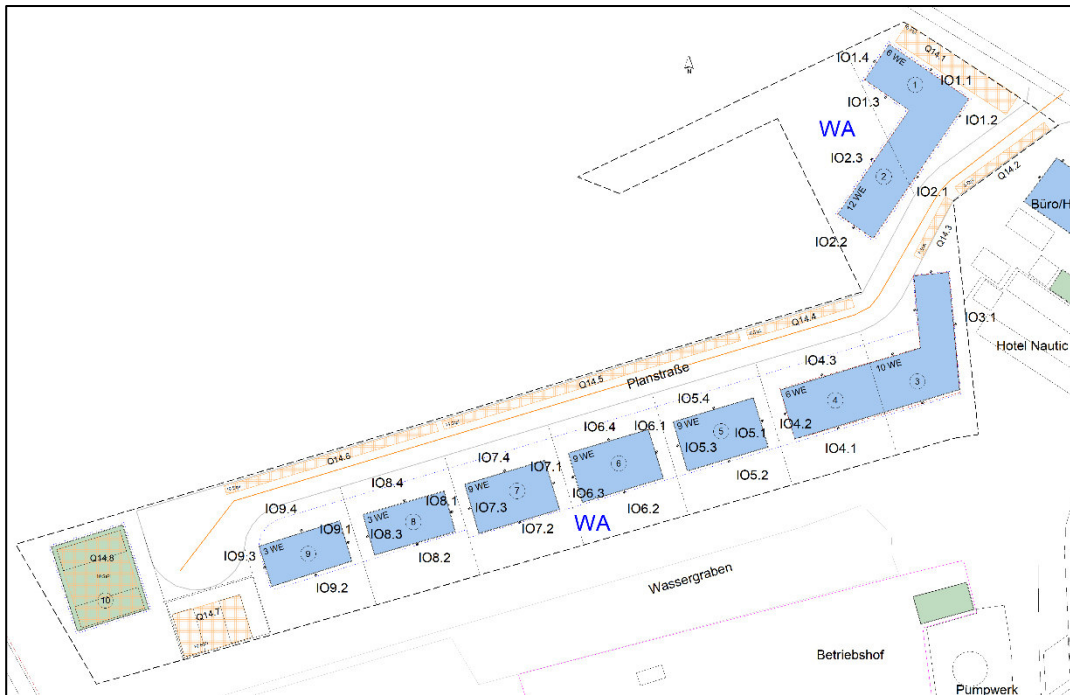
Lage der nichtöffentlichen Stellplätze und der Planstr. des Bauvorhabens
